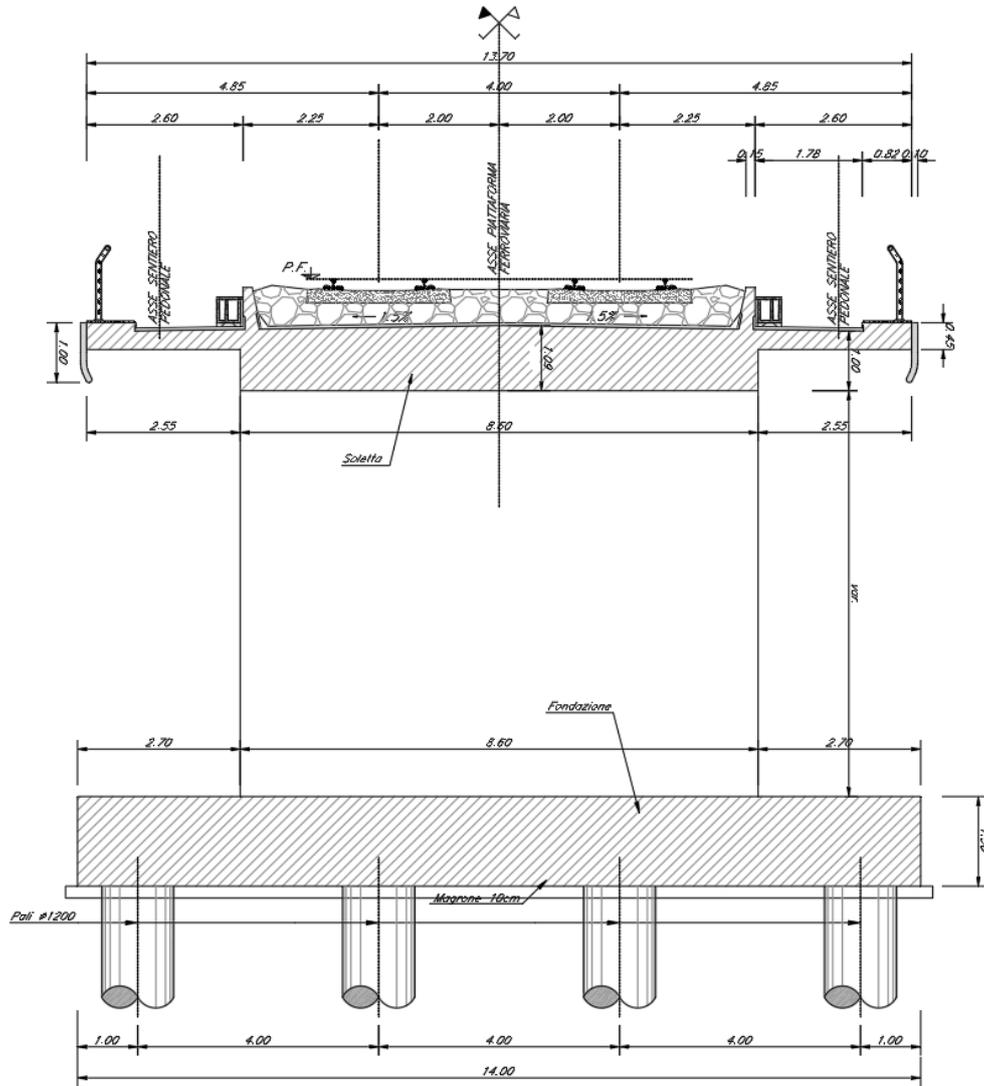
Sezione trasversale in corrispondenza dell'apertura
